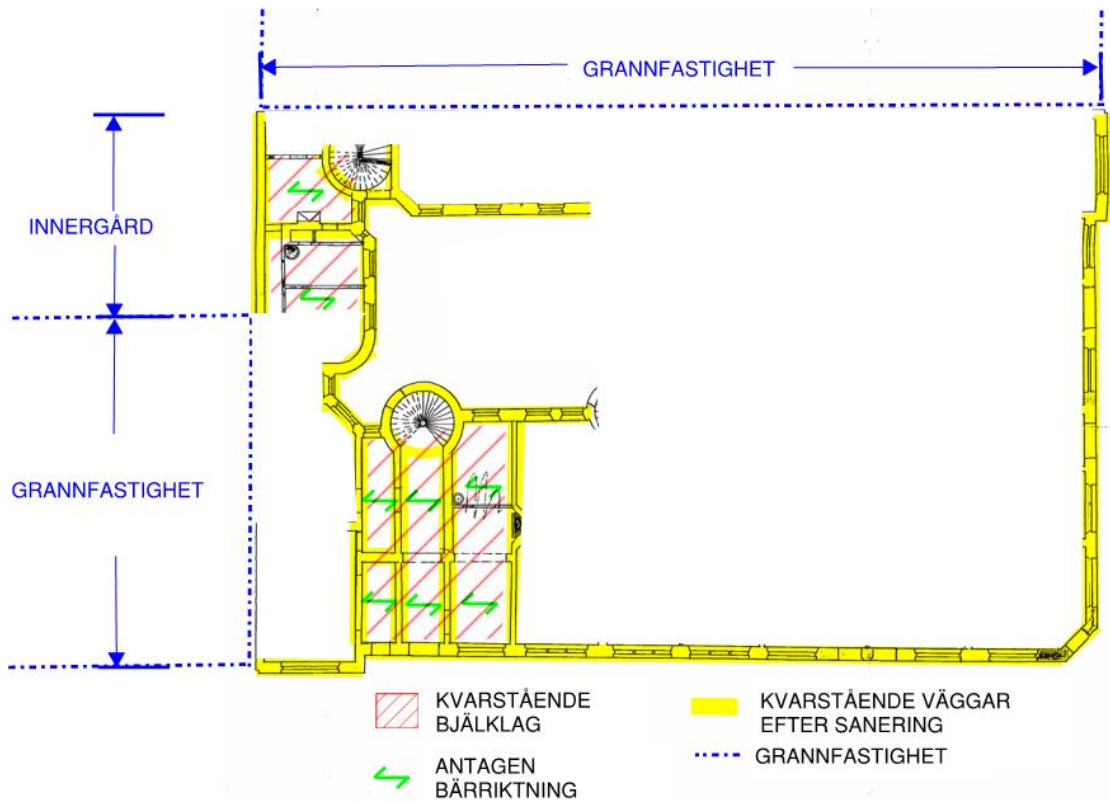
Bjälklag över plan 3. Konsekvenser på grund av rivning av befintliga konstruktioner. (2)
